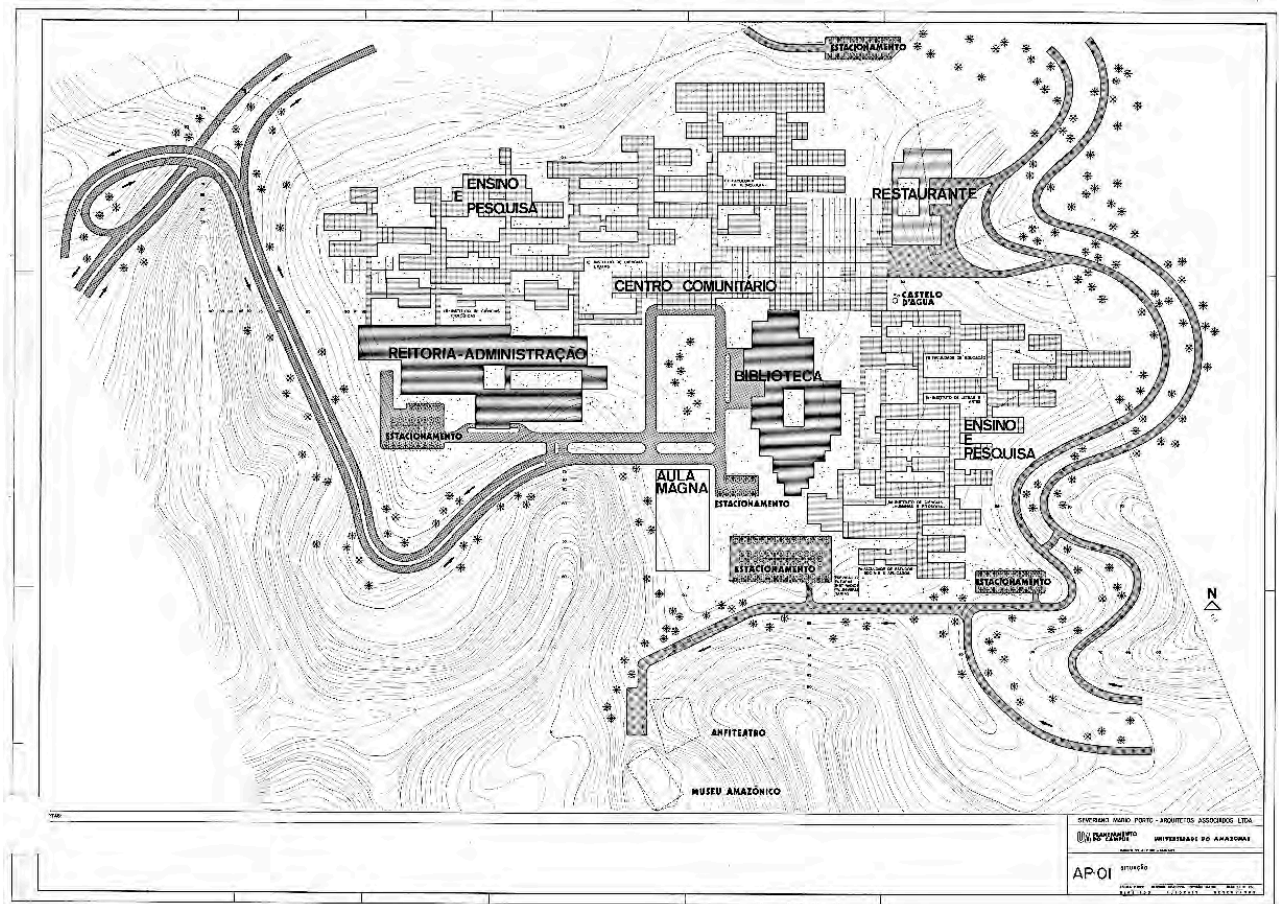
Setor norte do campus da UA. Planta de Situação, 1973.
